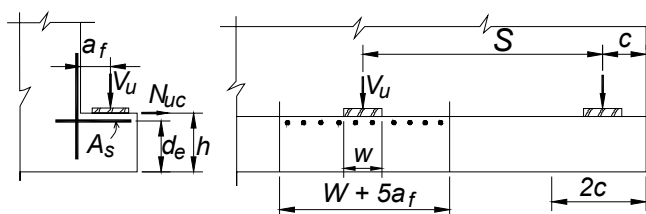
Diseño de los resaltos horizontales para flexión y fuerza horizontal
